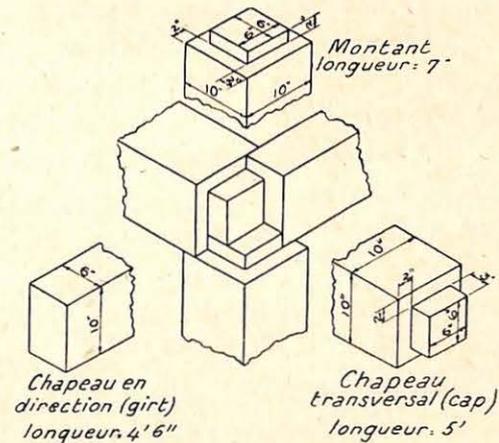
b. Assemblage des square-sets en bois équarris (Butte sets)
